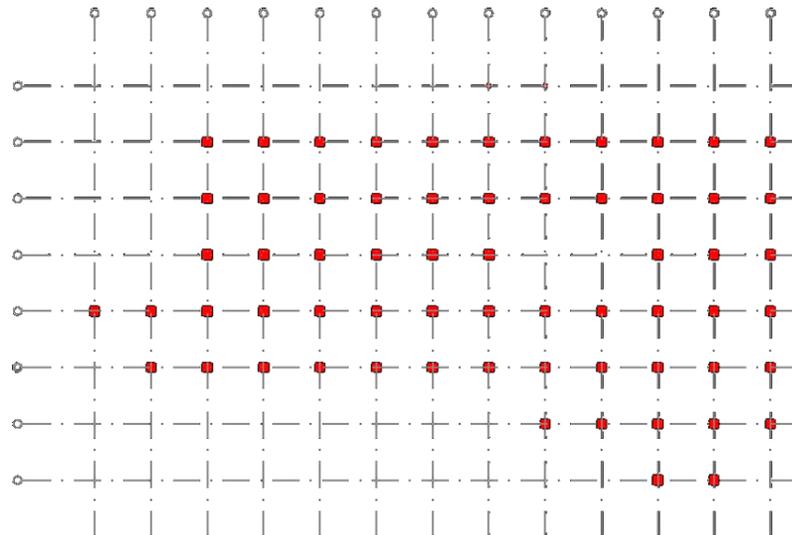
Malla estructural de 7.20 x 7.20 m
